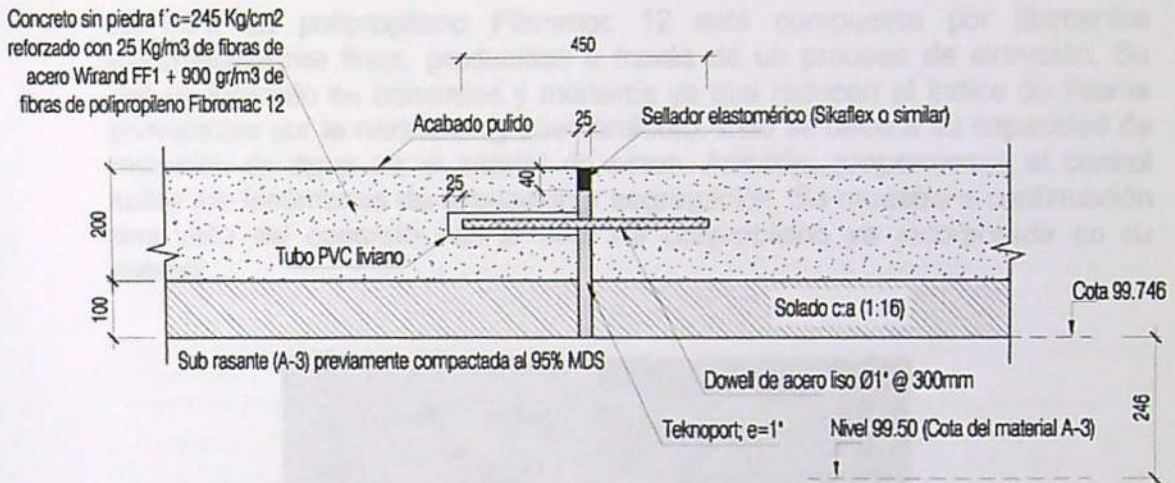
Sección típica del pavimento rígido construido en Iquitos que se muestra en la Fotografía N° 09. Su comportamiento a la fecha es adecuado y no presenta problemas de fisuración. Constituye un buen ejemplo de aplicación de concreto reforzado con fibras de acero y de polipropileno simultáneamente.
